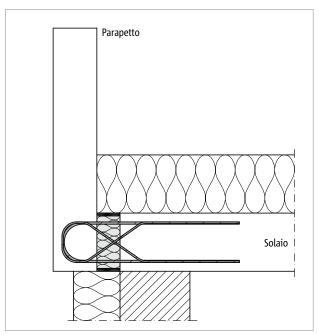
Schöck Isokorb® T tipo AP disposizione orizzontale: raccordo di un parapetto frontale
